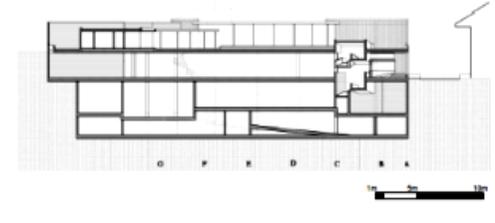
Corte D. Fuente: Los planos del proyecto, son cortesía del archivo de planos de Rogelio
